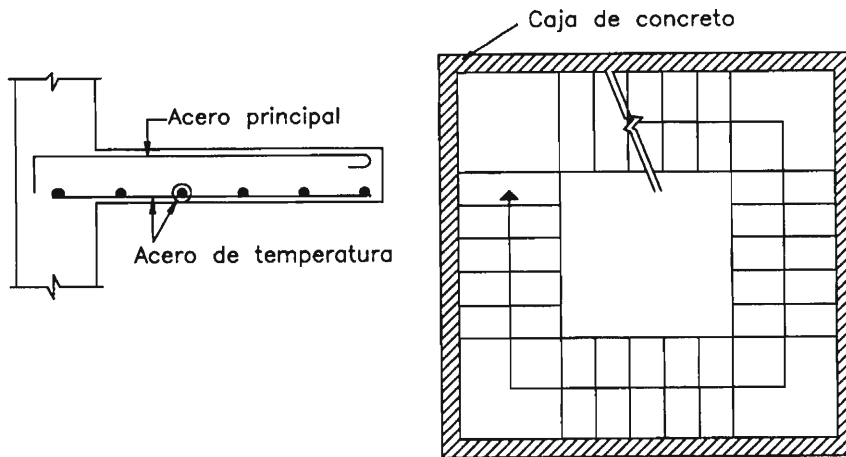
Escalera desarrollada dentro de caja de concreto
